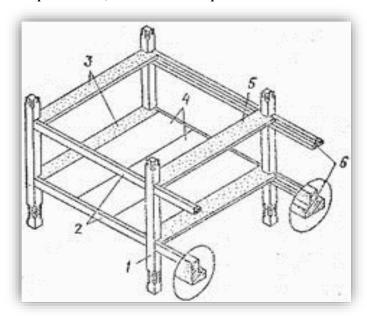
Конструктивные элементы сборного железобетонного каркаса гражданского здания
